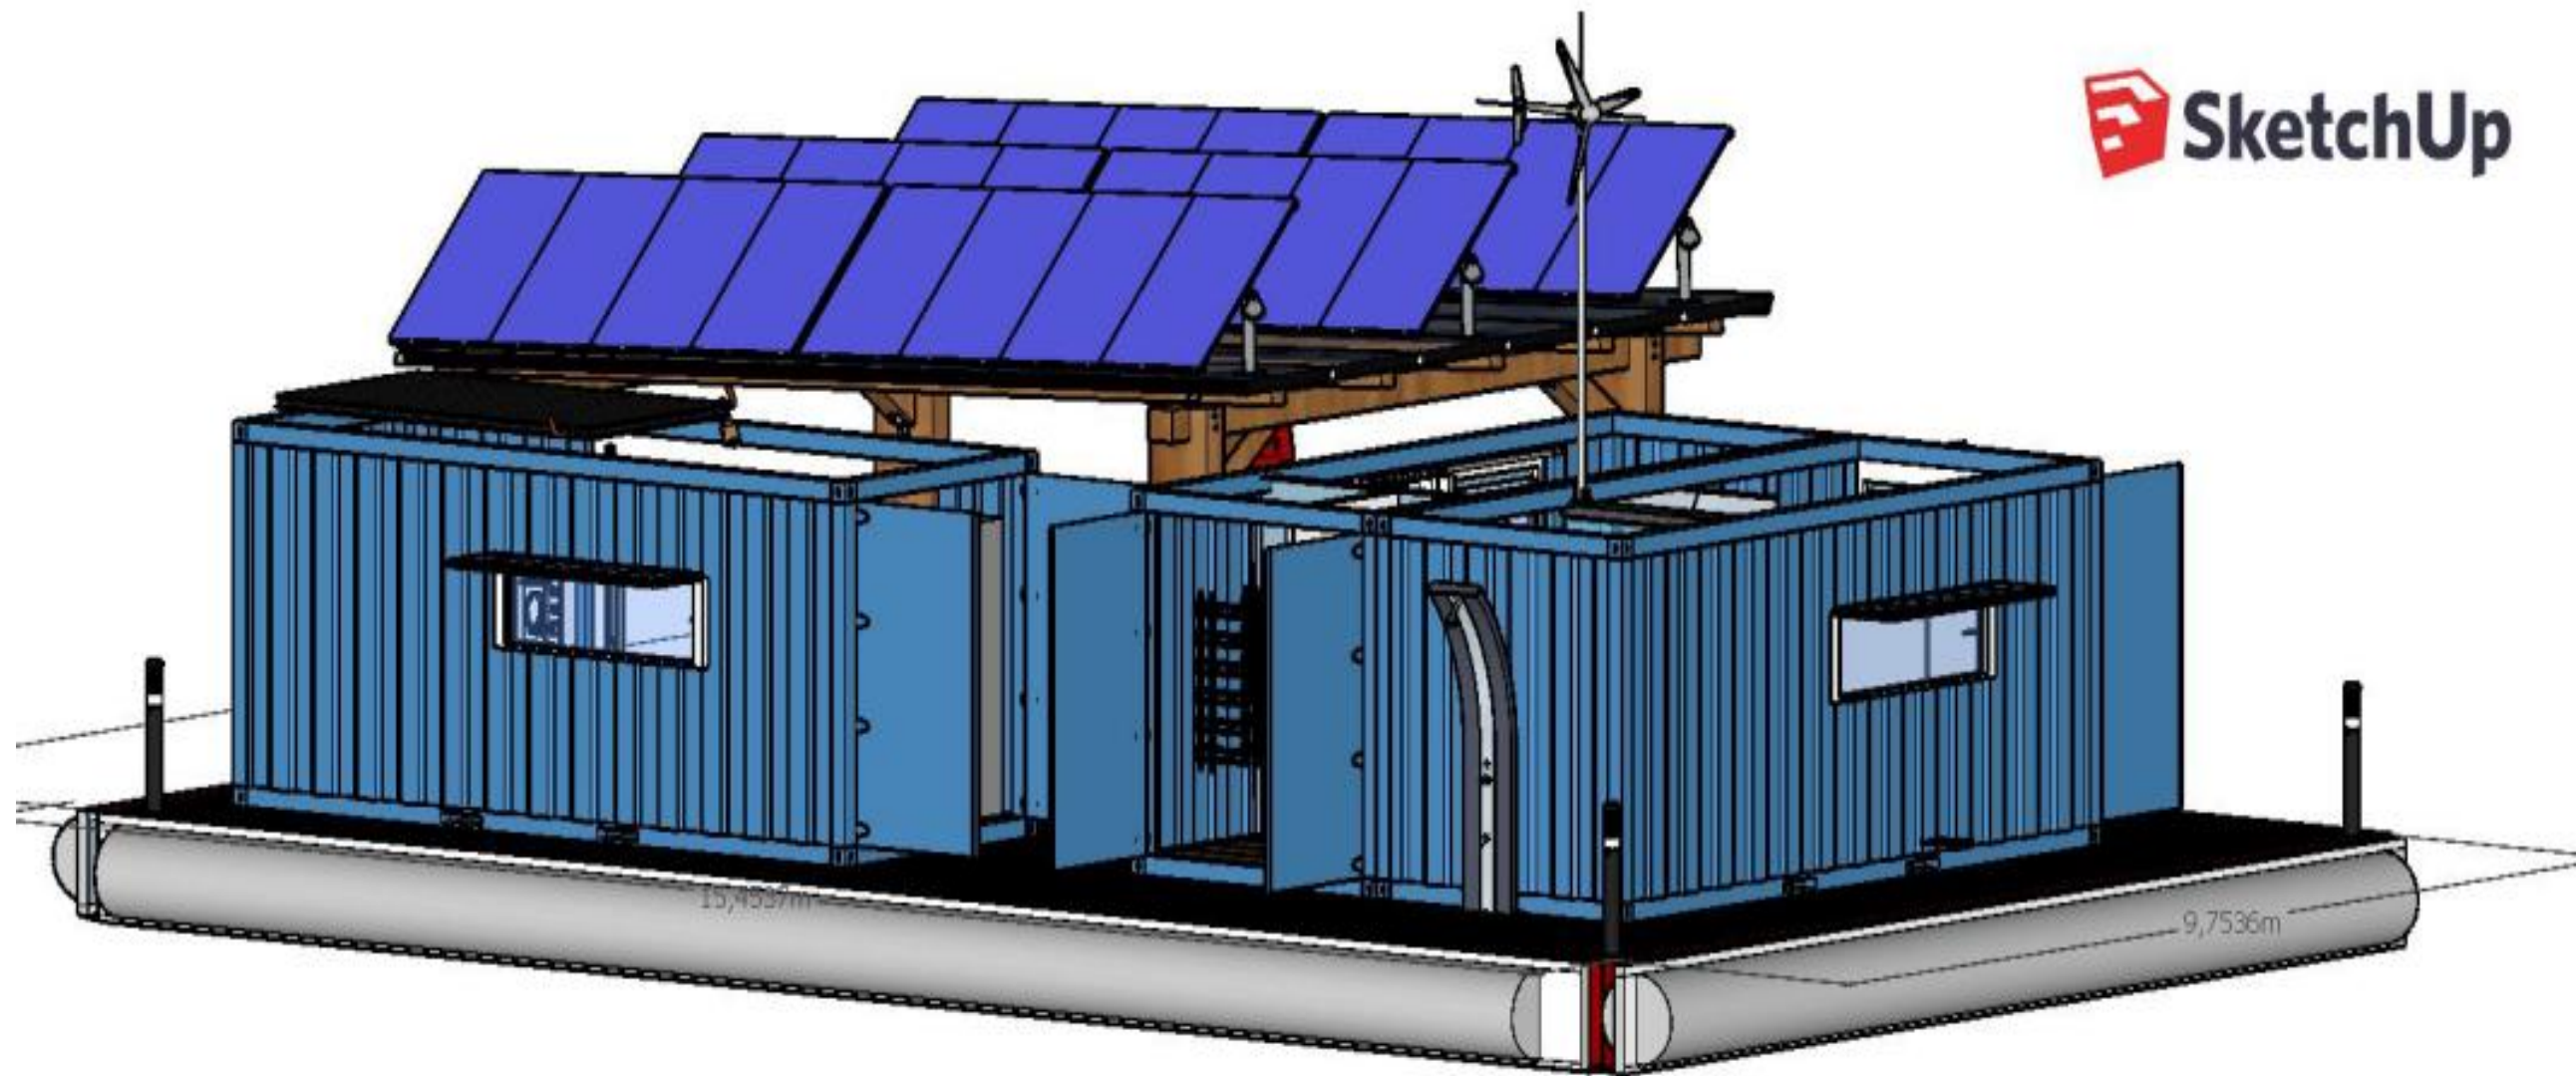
Vista en planta del diseño arquitectónico de la plataforma OPOMLI.
